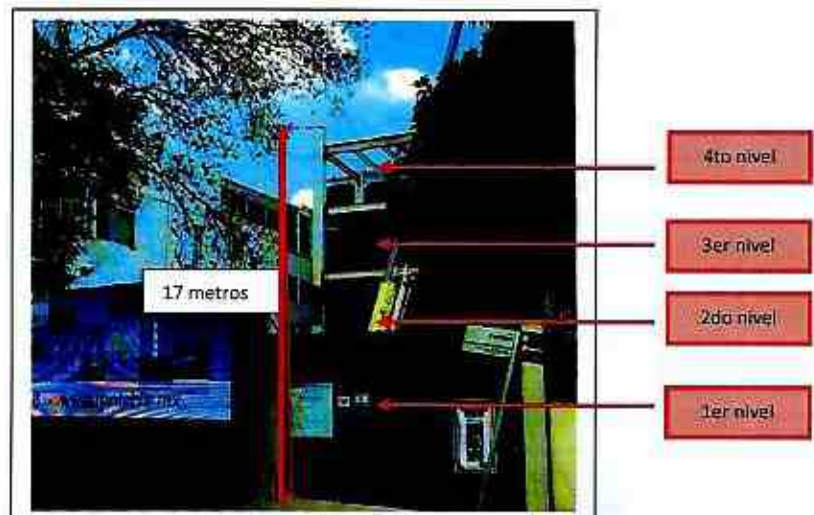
se observa la construcción de 4 niveles en 17 metros
